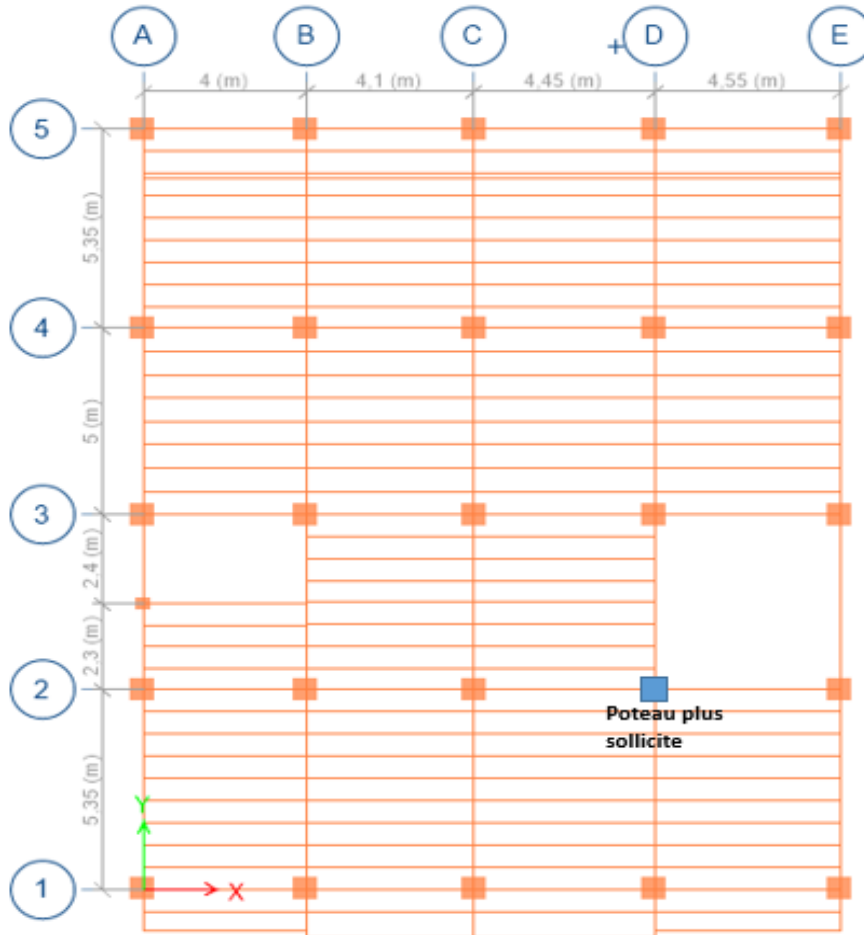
Schéma de disposition des poutrelles et le poteau le plus sollicité.
